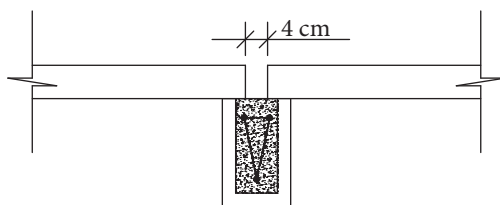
Opção para detalhe contra colapso progressivo em painéis de lajes pré-moldadas sem ligação entre estes.
